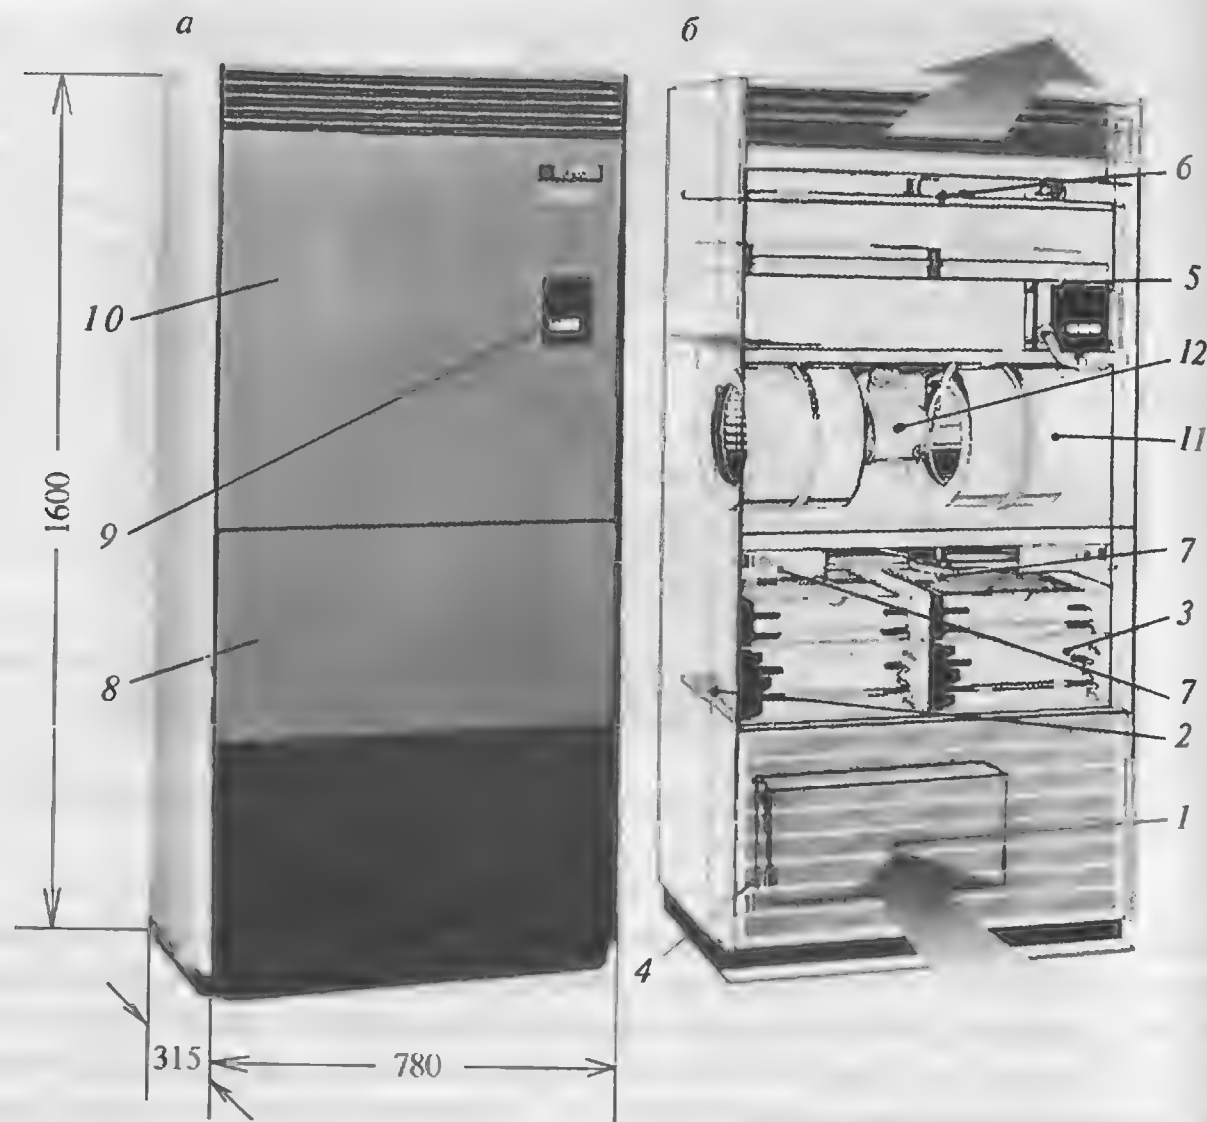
Агрегат тонкой очистки воздуха в помещениях общественных зданий: а) внешний вид; б) конструктивная схема
